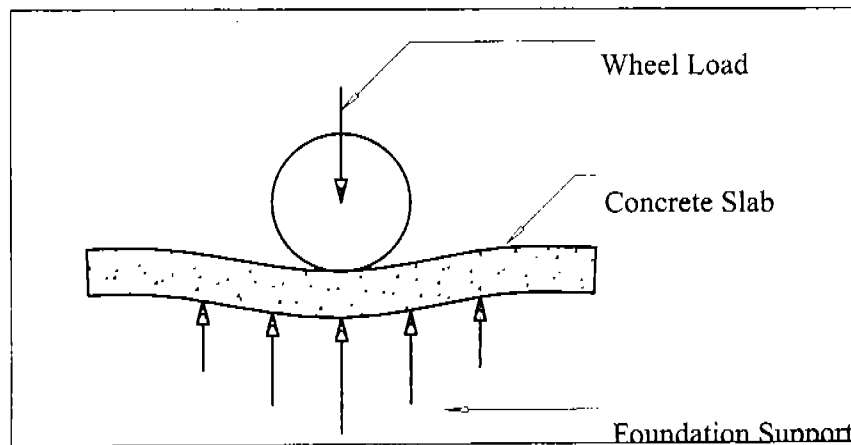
TRANSFERENCIA DE CARGA DE LA RUEDA AL TERRENO DE FUNDACION EN ESTRUCTURA DE PAVIMENTO RIGIDO.
